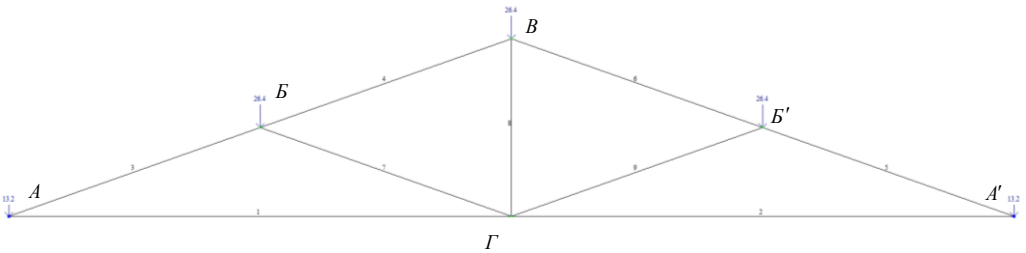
в. Розрахункова схема ферми: снігове на весь проліт
